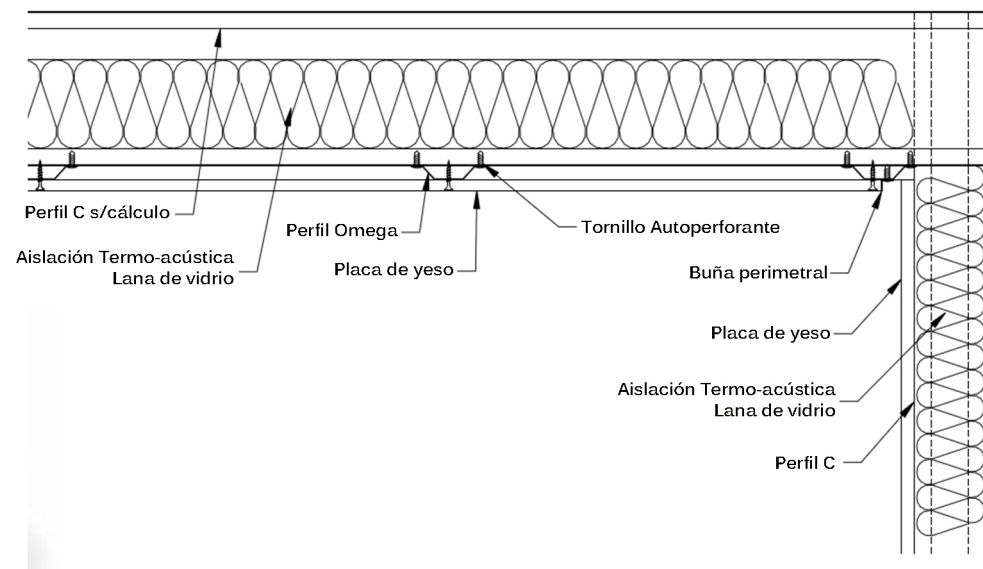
Detalle de Cielo raso aplicado con montante u omegas.
